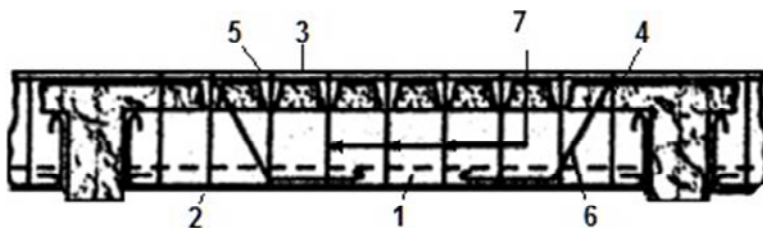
Усиление монолитной балки железобетонной обоймой:
